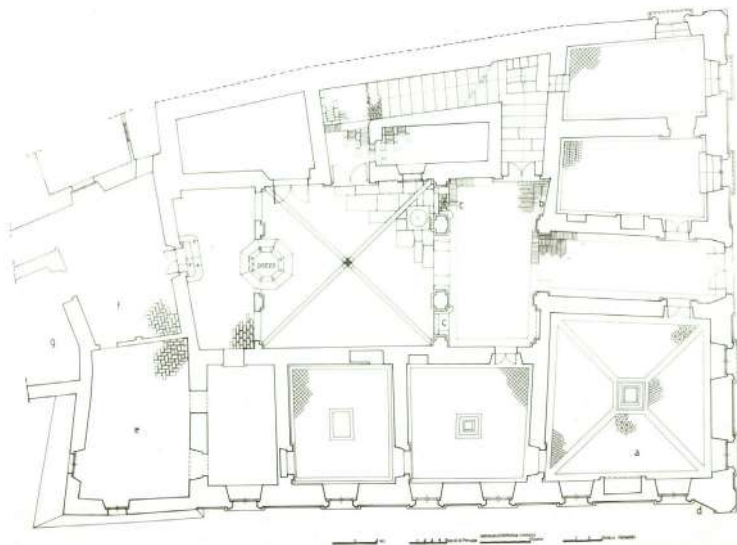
Palazzo Atti, Todi. Pianta del piano terra (elaborazione dell'autore).
